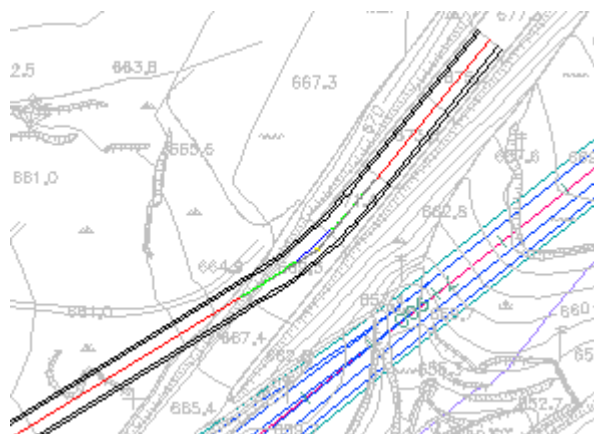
Pormenor da Planta do Ponto Final do Restabelecimento Norte
